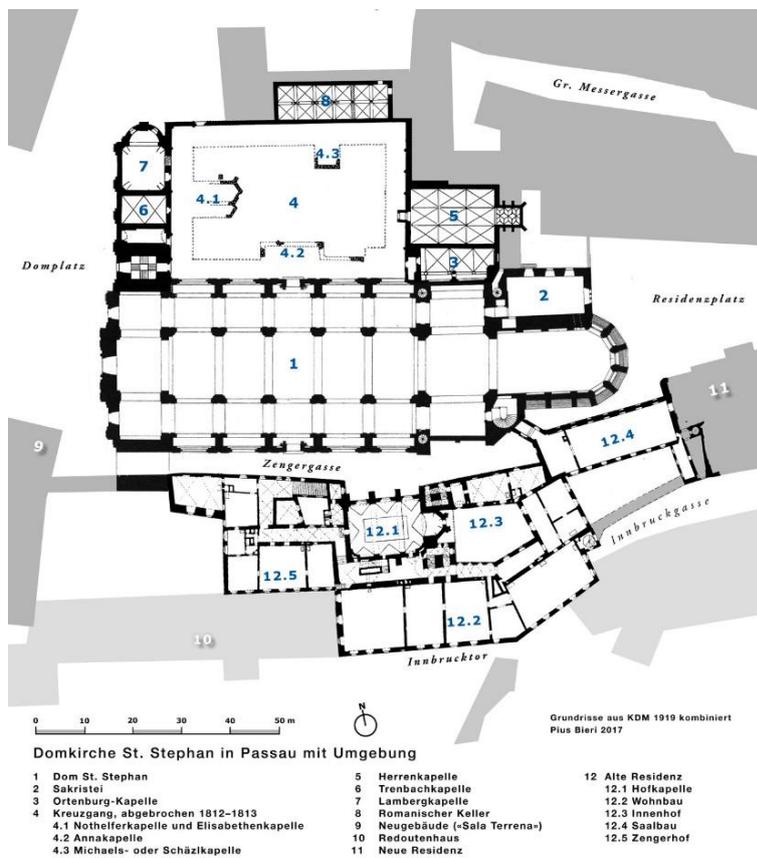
Grundriss und Umgebungsplan des Passauer Doms, nach Bieri
